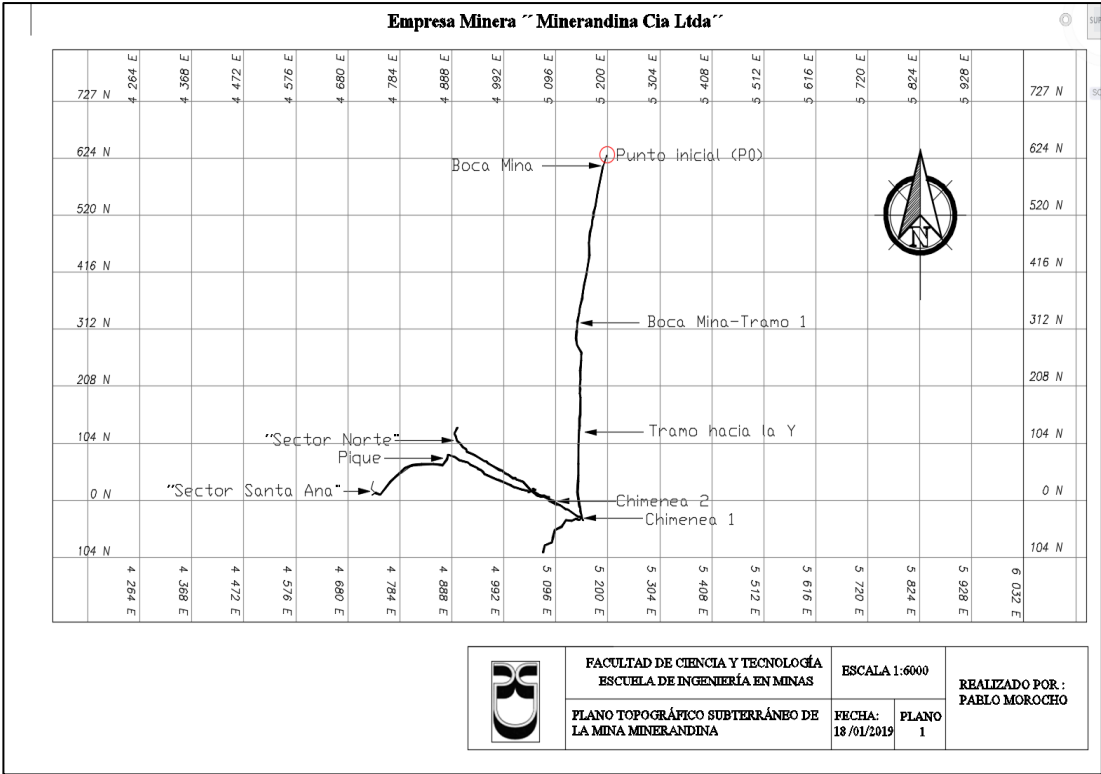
Vista en planta de la mina Minerandina Cía. Ltda.
